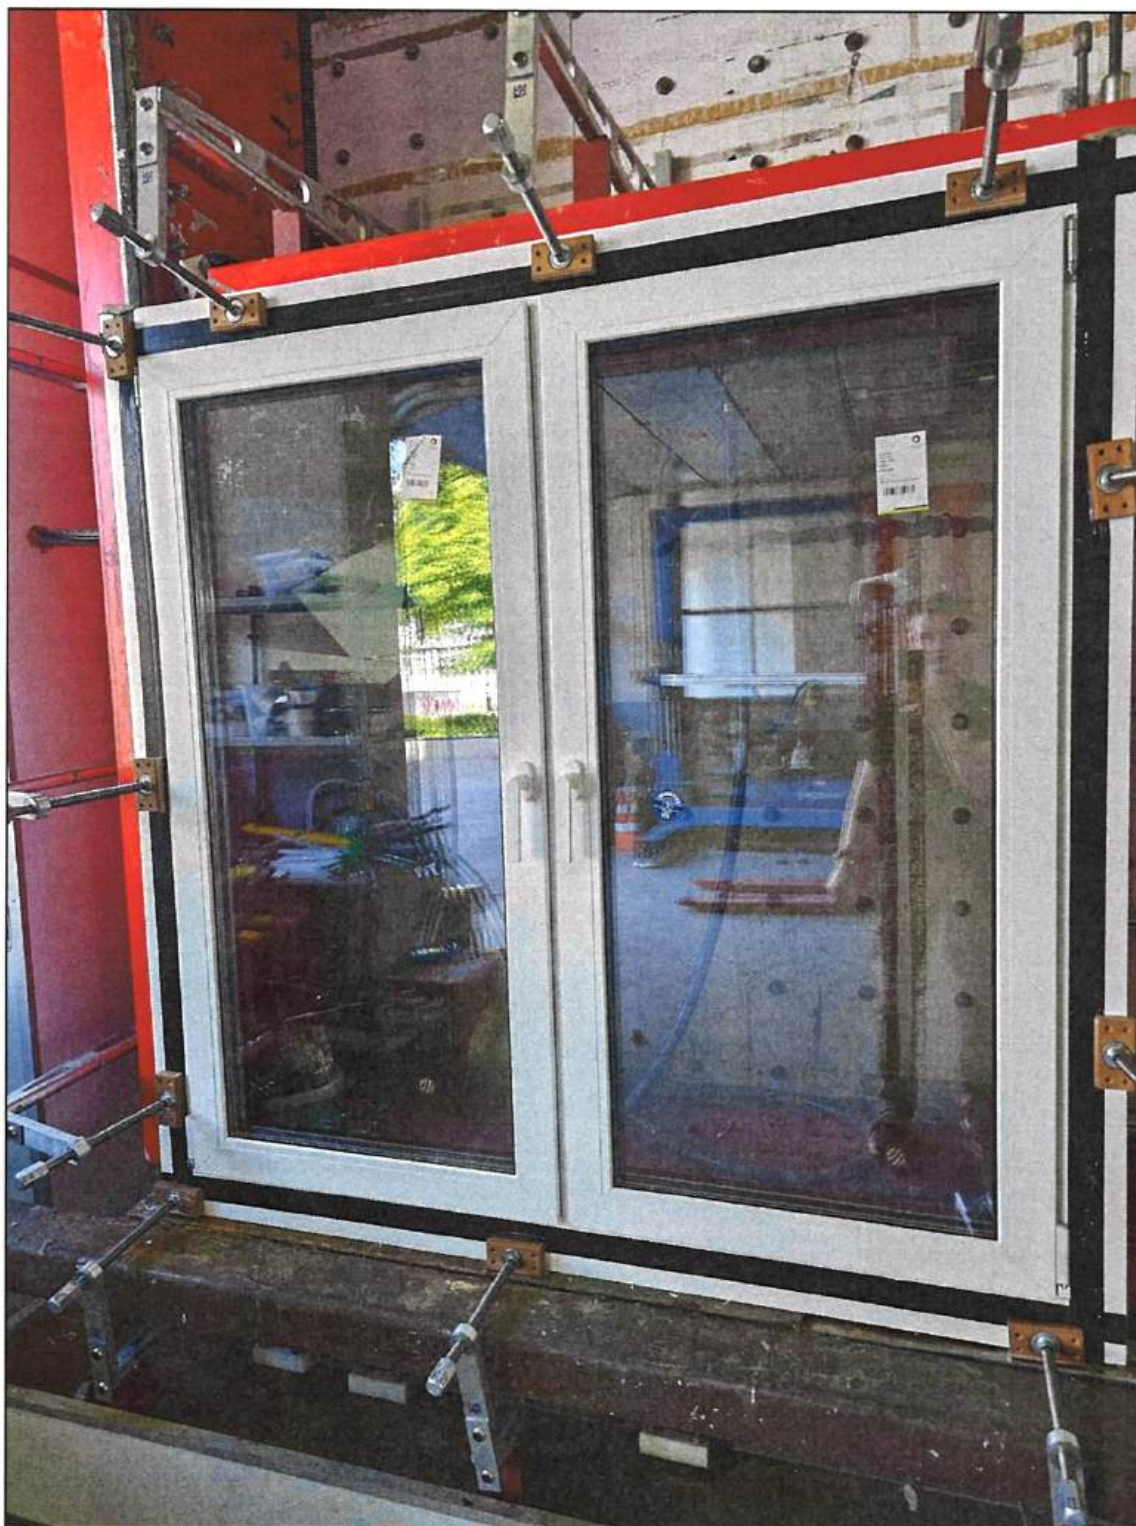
Образец 994-24-2-2, установленный на испытательный стенд
